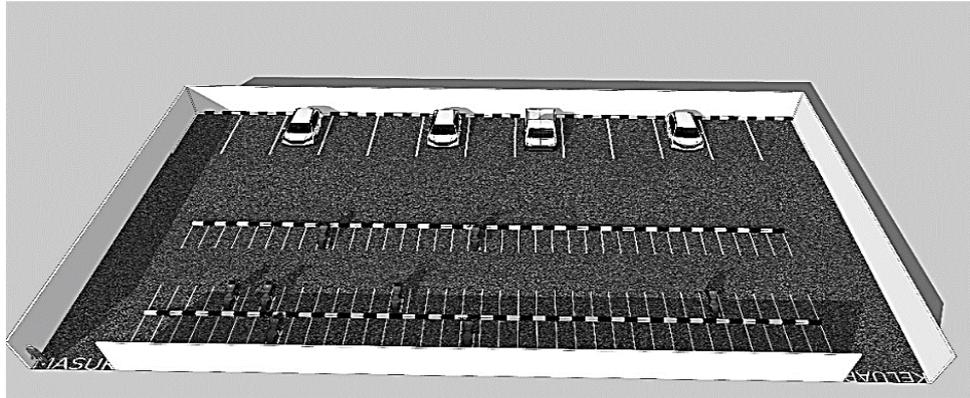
Layout Ruas Jalan Yang Dapat di Akses Menuju Parkir Off Street
